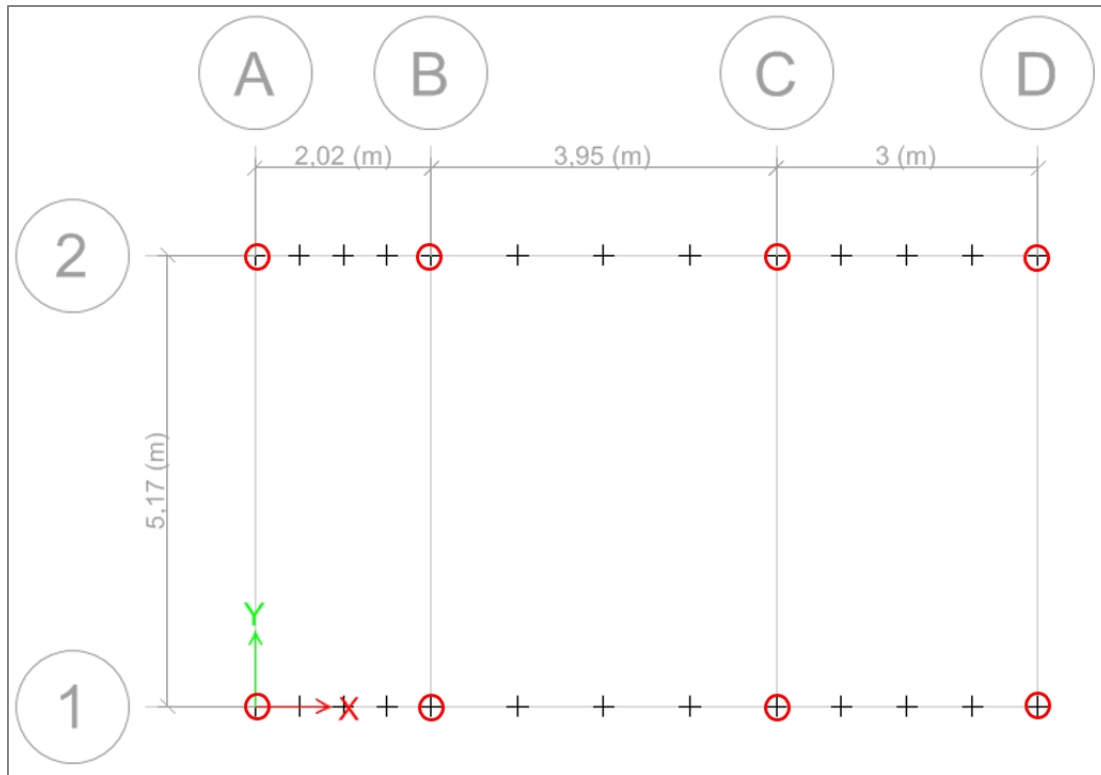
Notación de ejes para ubicación de zapatas edificio 2.
